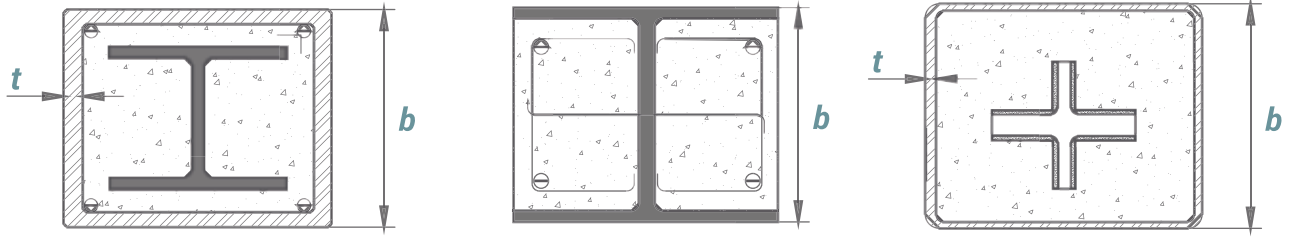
Columnas compuestas acero-concreto perfiles de acero embebidos en concreto reforzado.
